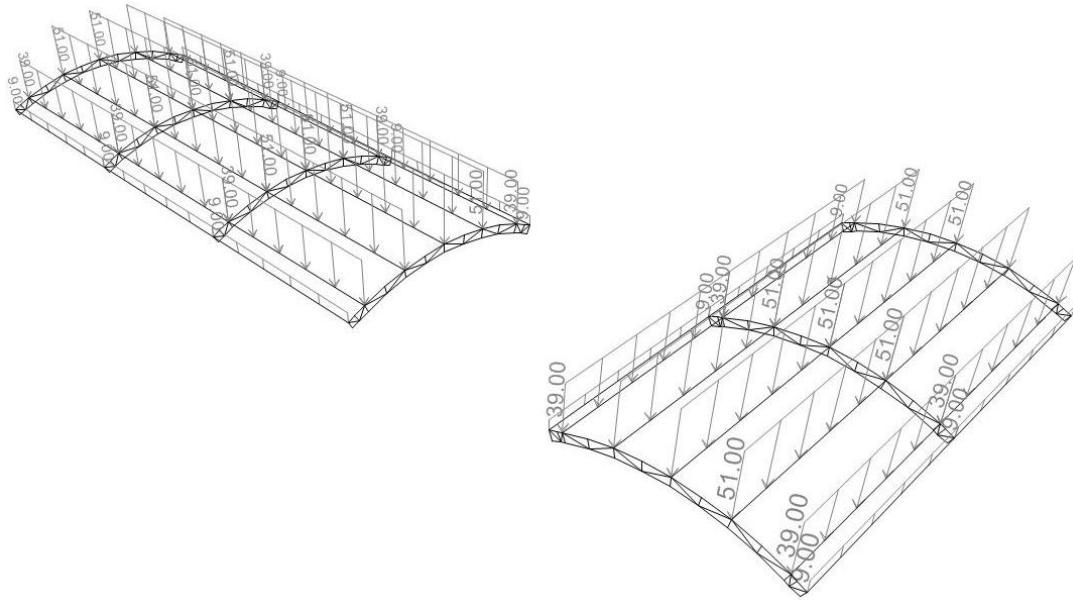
Asignación de carga viva sobre elementos de la cubierta metálica
